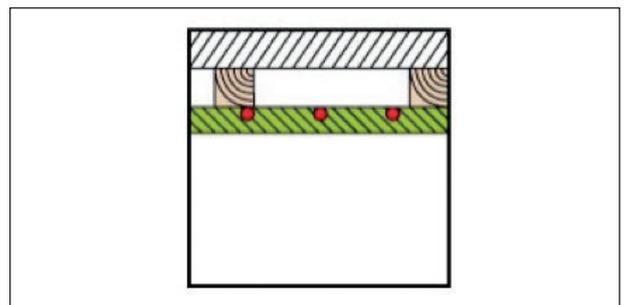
TD1 - Rohrsystem in Trockenbau-Platte – Decke
